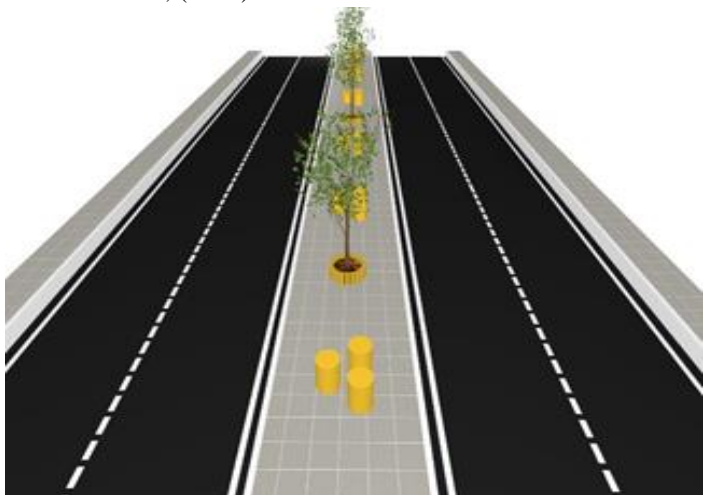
Canteiro central da Avenida Getúlio Vargas com as placas pré-moldadas de concreto com PET, vista longitudinal.
